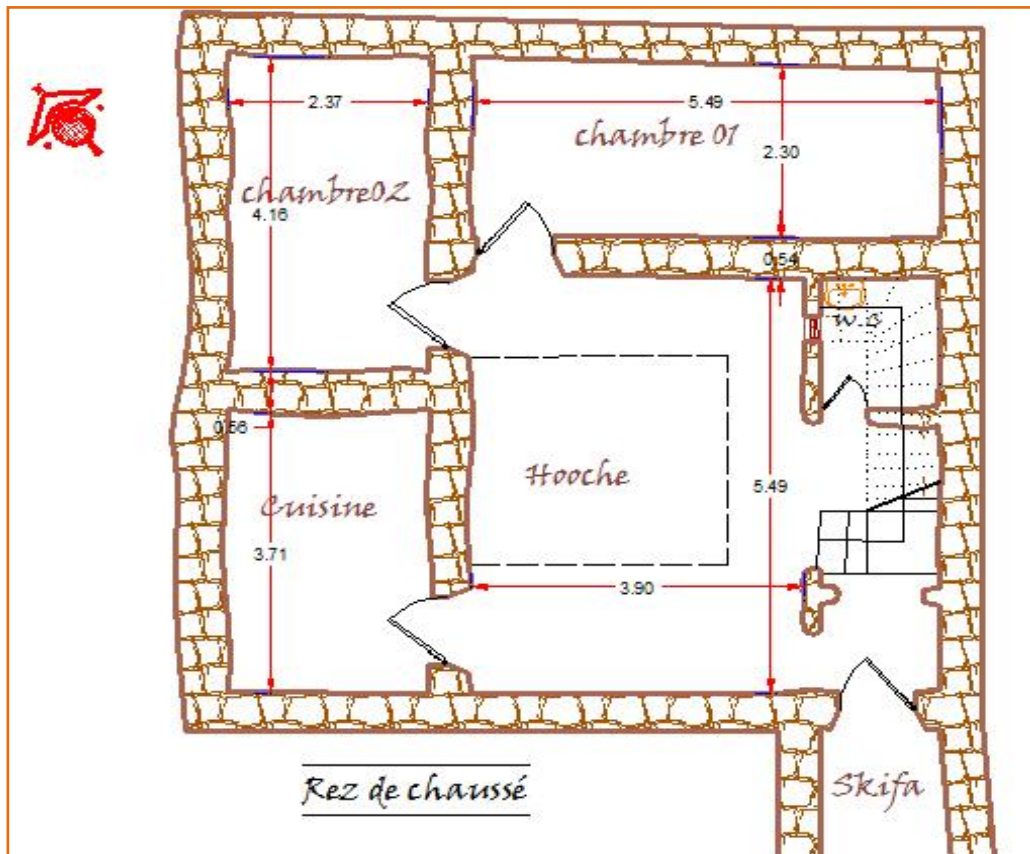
plan de rez de chaussé de la Maison du cas d'étude (Source: auteur)
